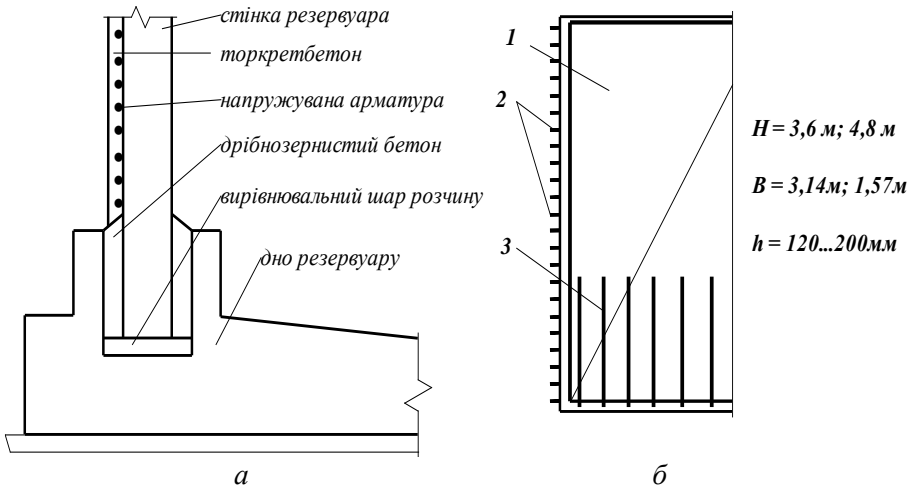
Конструювання циліндричного резервуару та армування окремих стінових панелей резервуару
